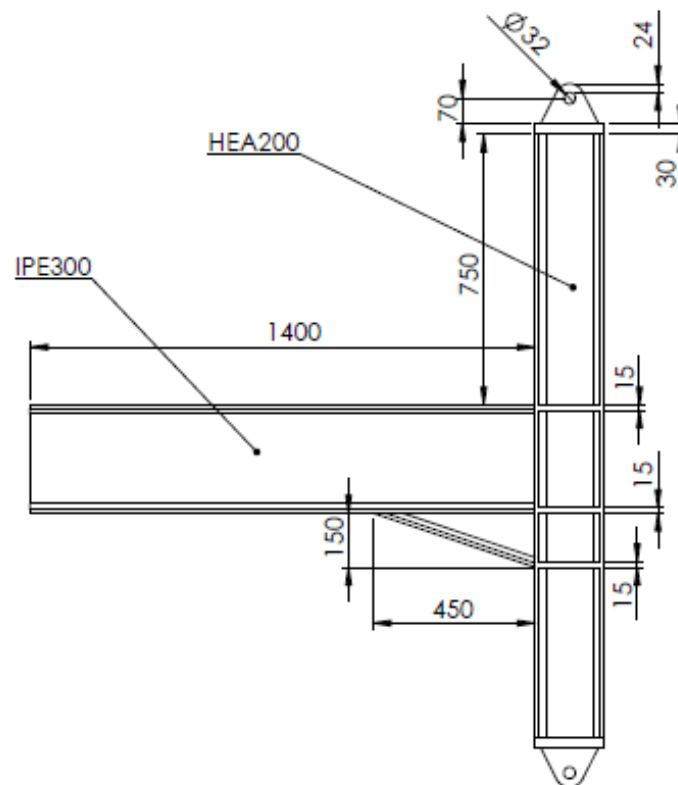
Modelo 3. Unión viga-pilar con tres rigidizadores. (Fuente: elaboración propia)
